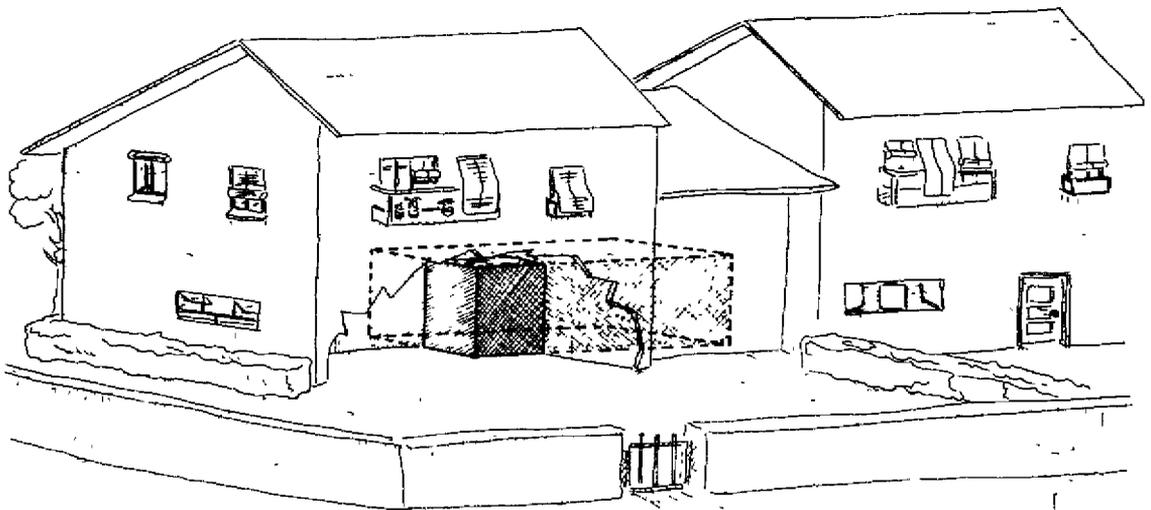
LA "ABERTURA" EN LA FACHADA PERMITE IMAGINAR LA DISPOSICION QUE DEBE TENER UN REFUGIO EN UNA CASA SIN SOTANO EL ELEMENTO MAS DENSAMENTE RAYADO ES EL REFUGIO EN SI, Y ESTA COLOCADO APROXIMADAMENTE EN MITAD DE LA PLANTA LA ZONA MENOS RAYADA SON AREAS AUXILIARES ACONDICIONADAS CON MATERIAL DE BLINDAJE
